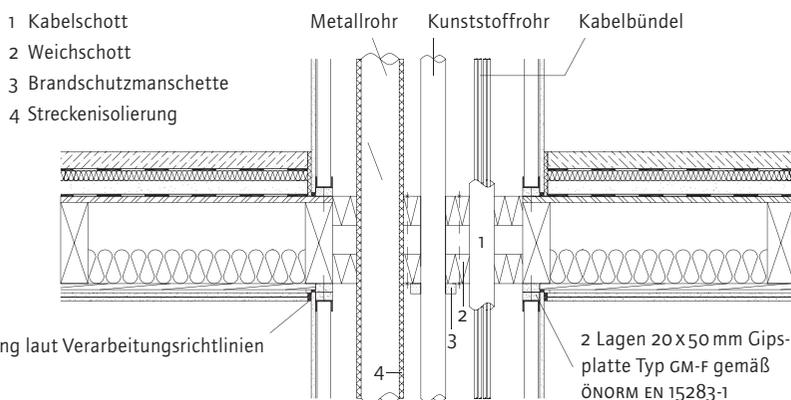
Beispielhafte Ausbildung einer horizontalen Abschottung im Bereich einer Holzrahmendecke (Schachttyp B)
